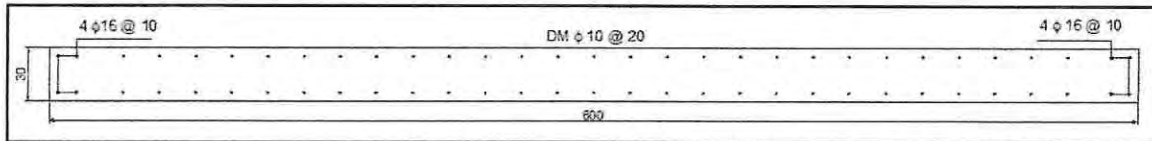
Armadura de flexo-compresión Muro 1, Estructura V (Aislada).
